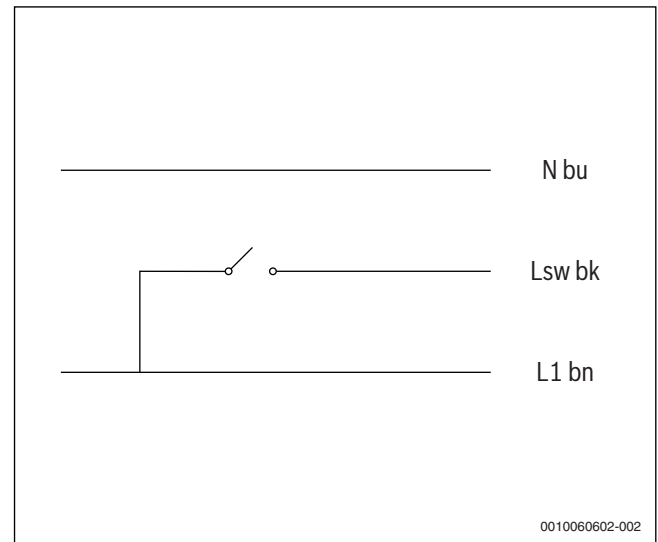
Elektrische Anschlüsse des Motors am 3-Wege-Ventil
